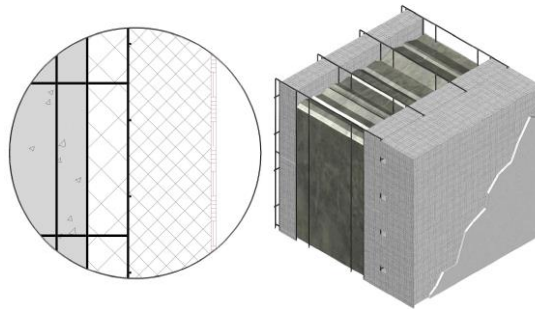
Sur un panneau Plus , enduit de ± 5 mm
